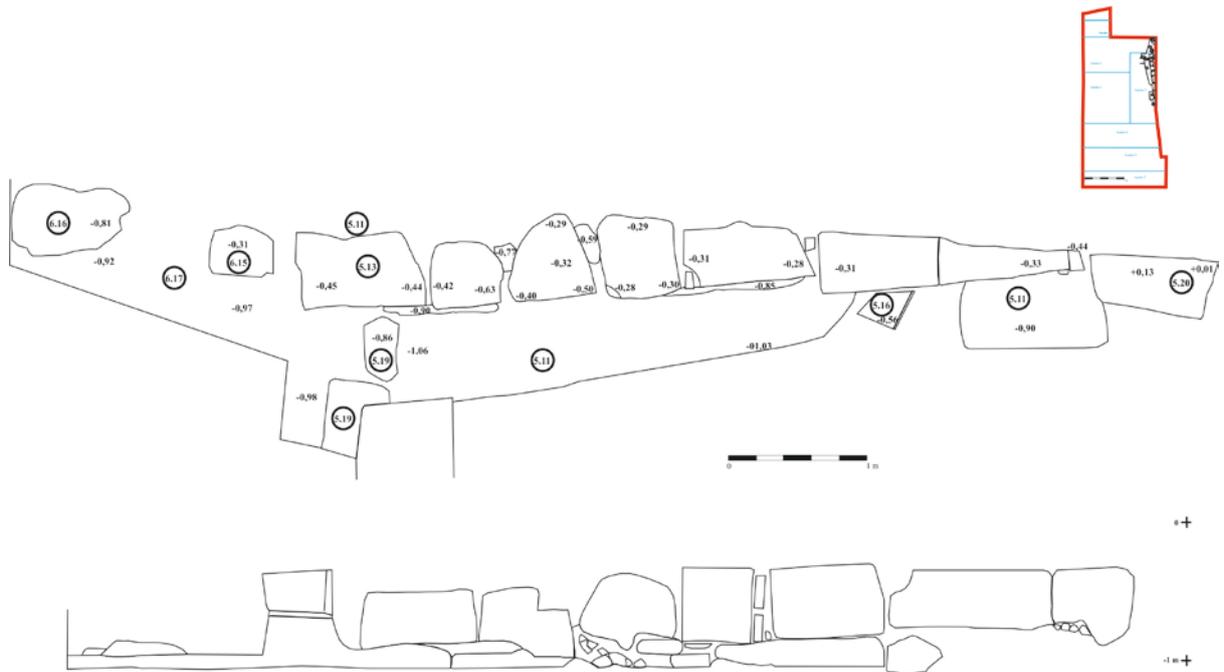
Época islámica. Planta y alzado del muro de sillares de calcarenita.
